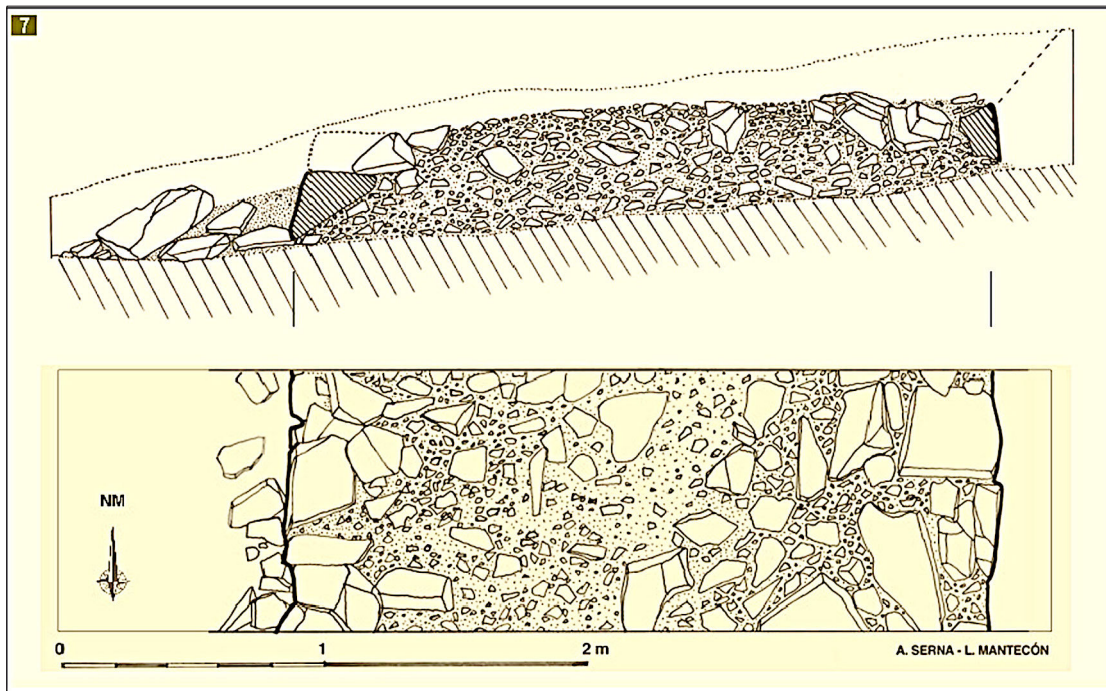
, Sección transversal y planta del sector excavado de la via praetoria en Cildá (Corvera de Toranzo y Arenas de Iguña)
